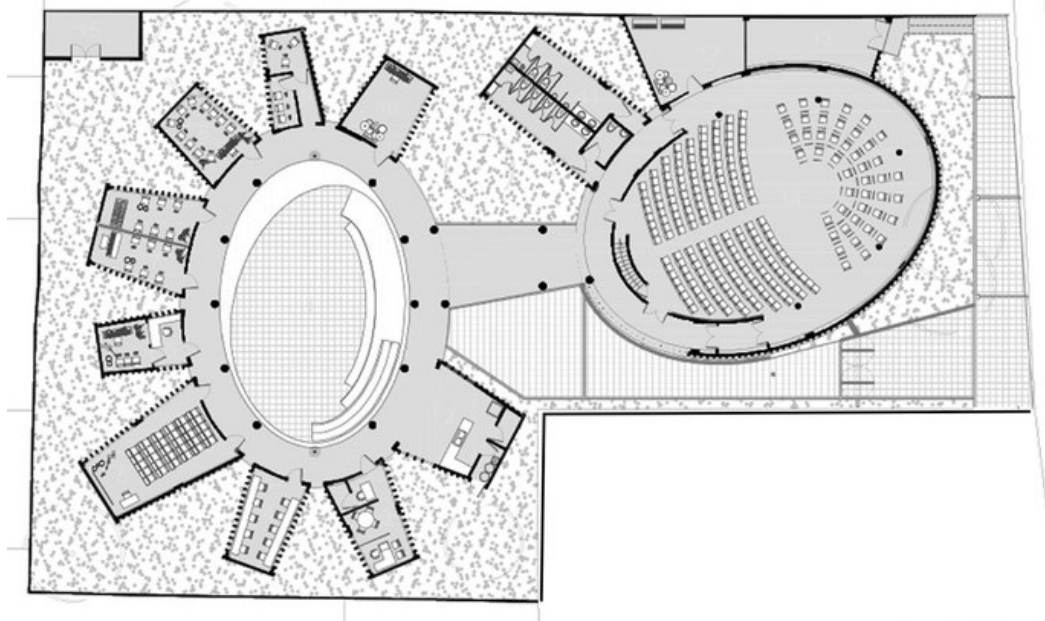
Escuela de Música Candelaria – Planta Arquitectónica
